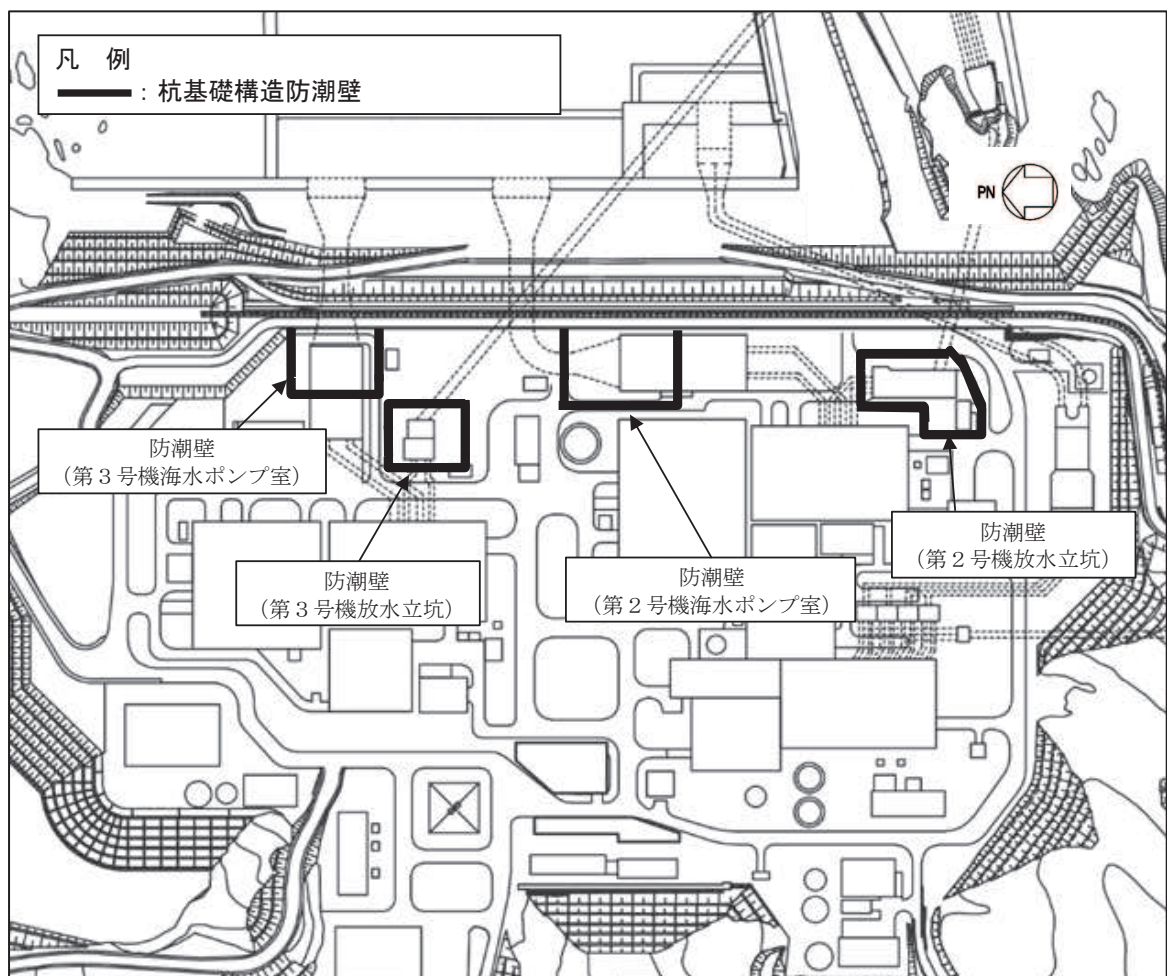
防潮壁（杭基礎）の平面配置図
